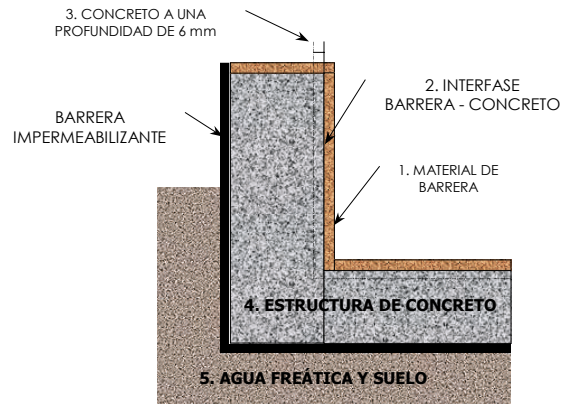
Elementos de un sistema de barrera protectora para estructuras de concreto subterráneas, vista esquemática de sección transversal. Fuente: ACI 515.1R-79(85).
